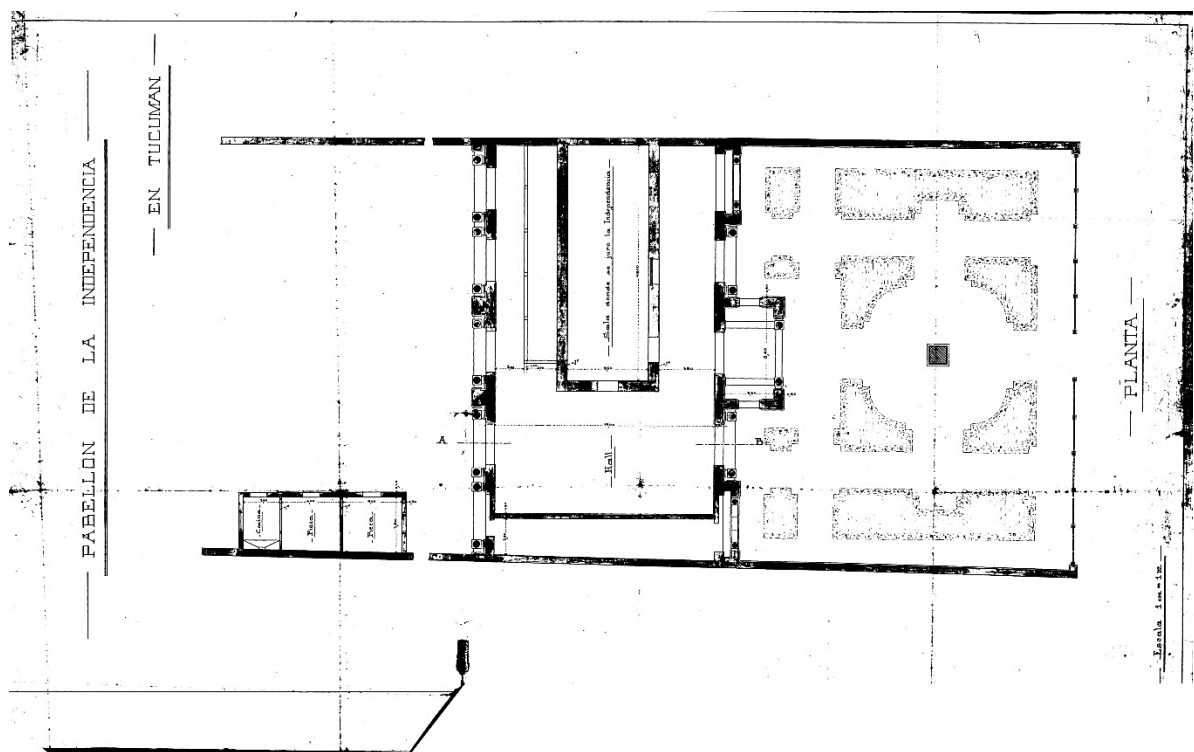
Planta del proyecto definitivo Plano N°11 DNOA
